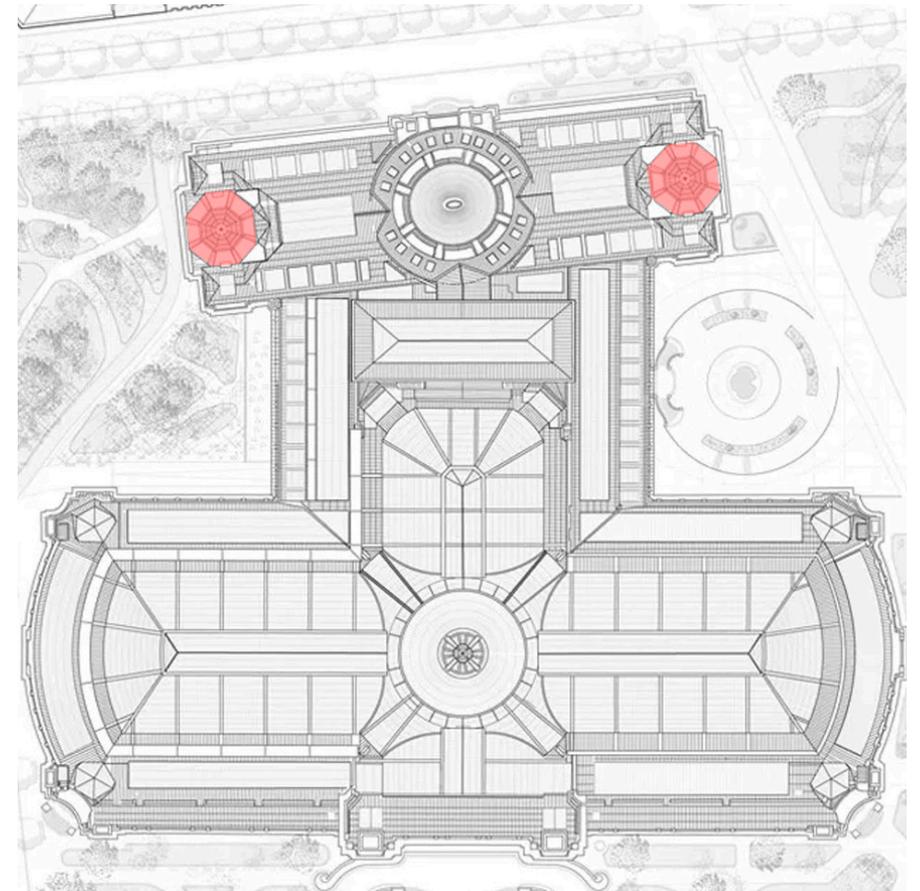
Planta de cubierta con las cúpulas octogonales remarcadas en rojo.
